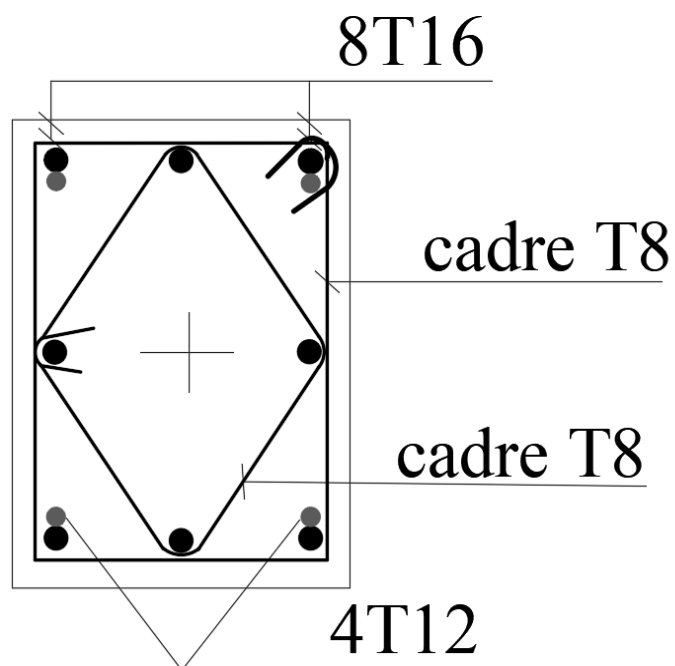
Ferrailage du poteau de section (40x55) cm²
